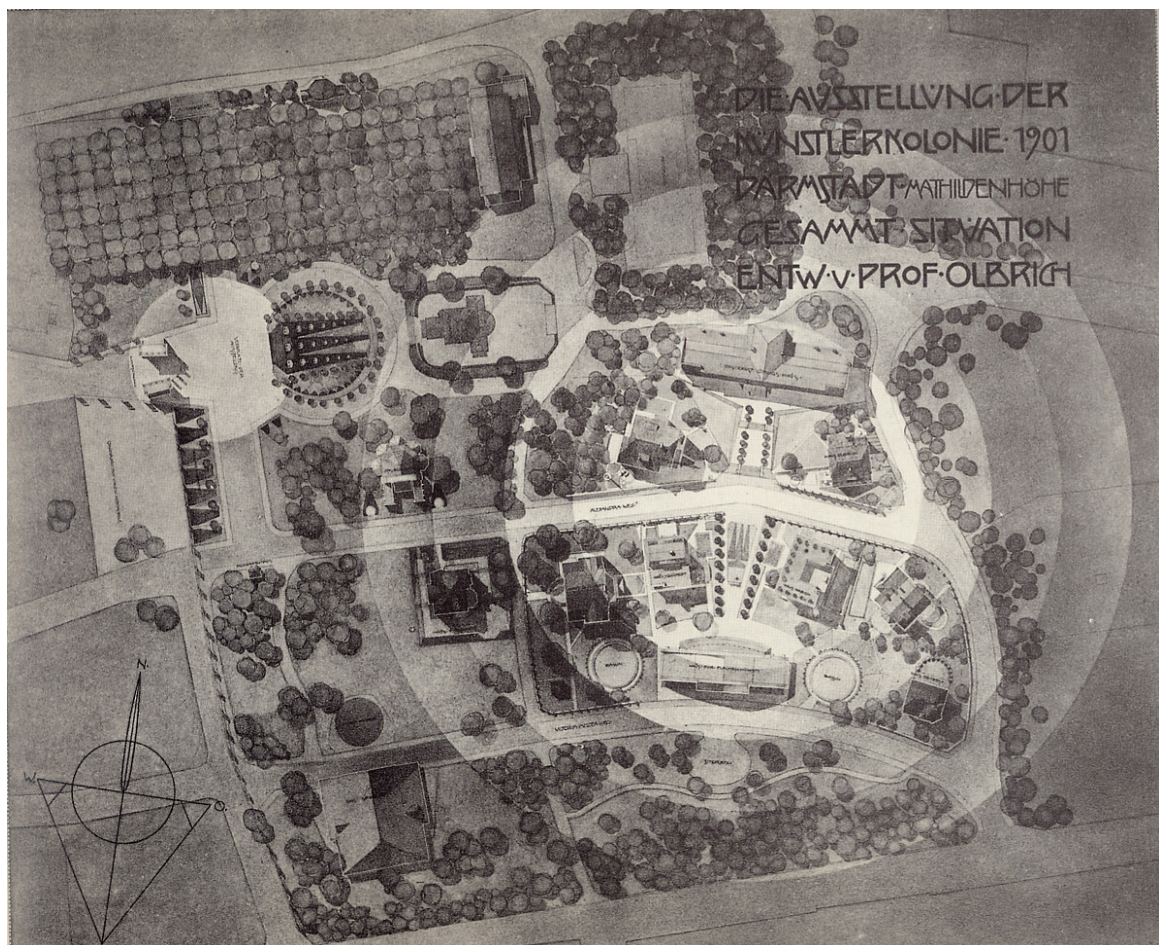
Planimetria definitiva dell'Esposizione, 1901, di J. M. Olbrich.
